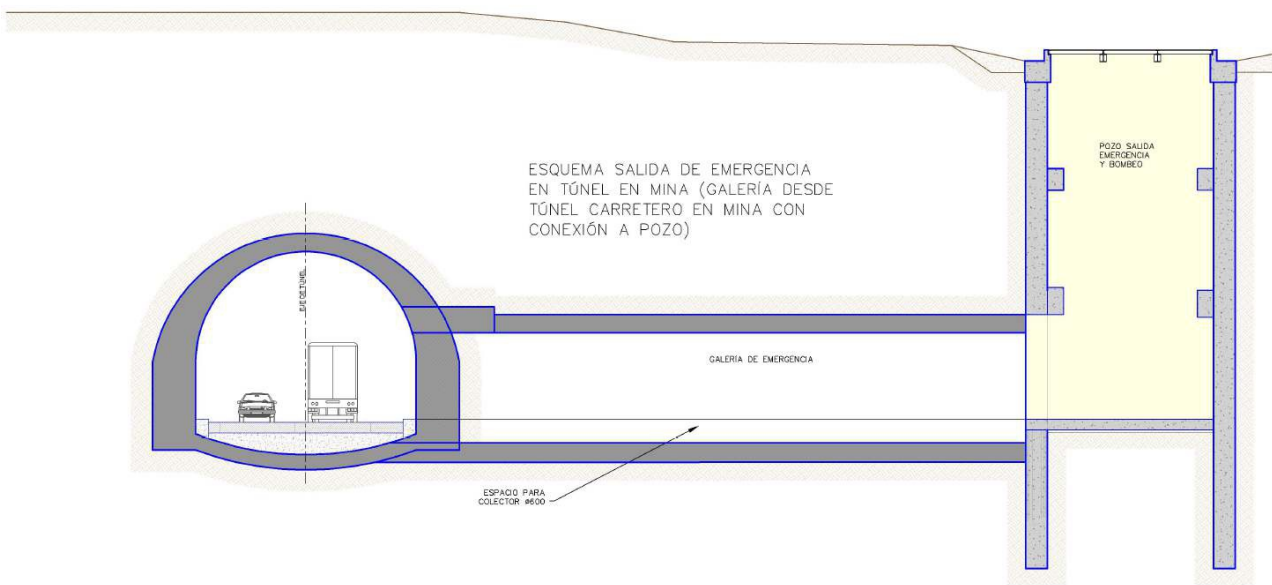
Esquema de posible conexión entre el túnel en mina carretero y pozo de salida de emergencia, espacio bajo pavimento de la galería disponible para colector (600mm).
